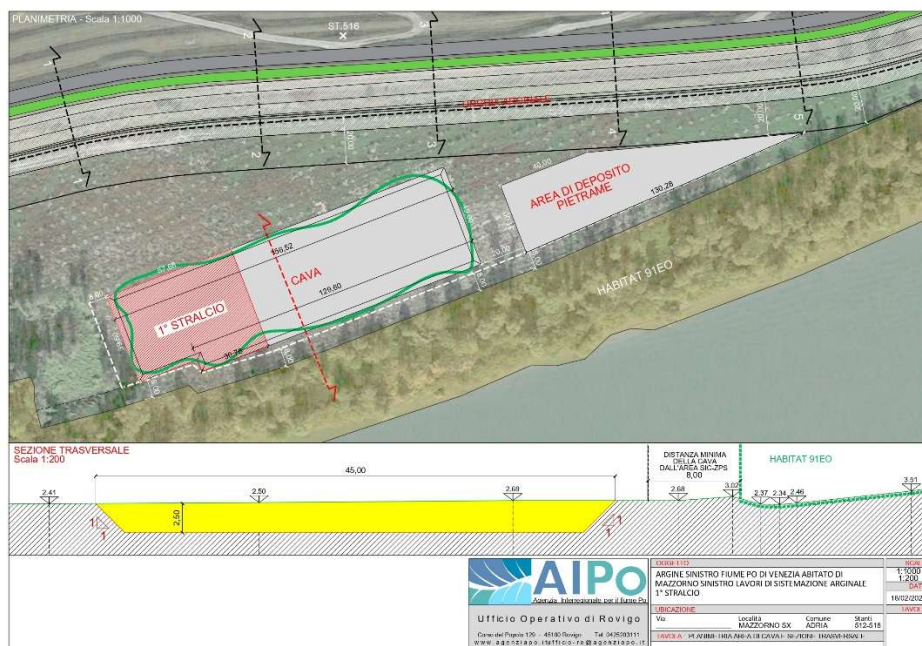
Località Mazzorno Sinistro – Planimetria e sezione trasversale scavo per prelievo materiale in golena.
